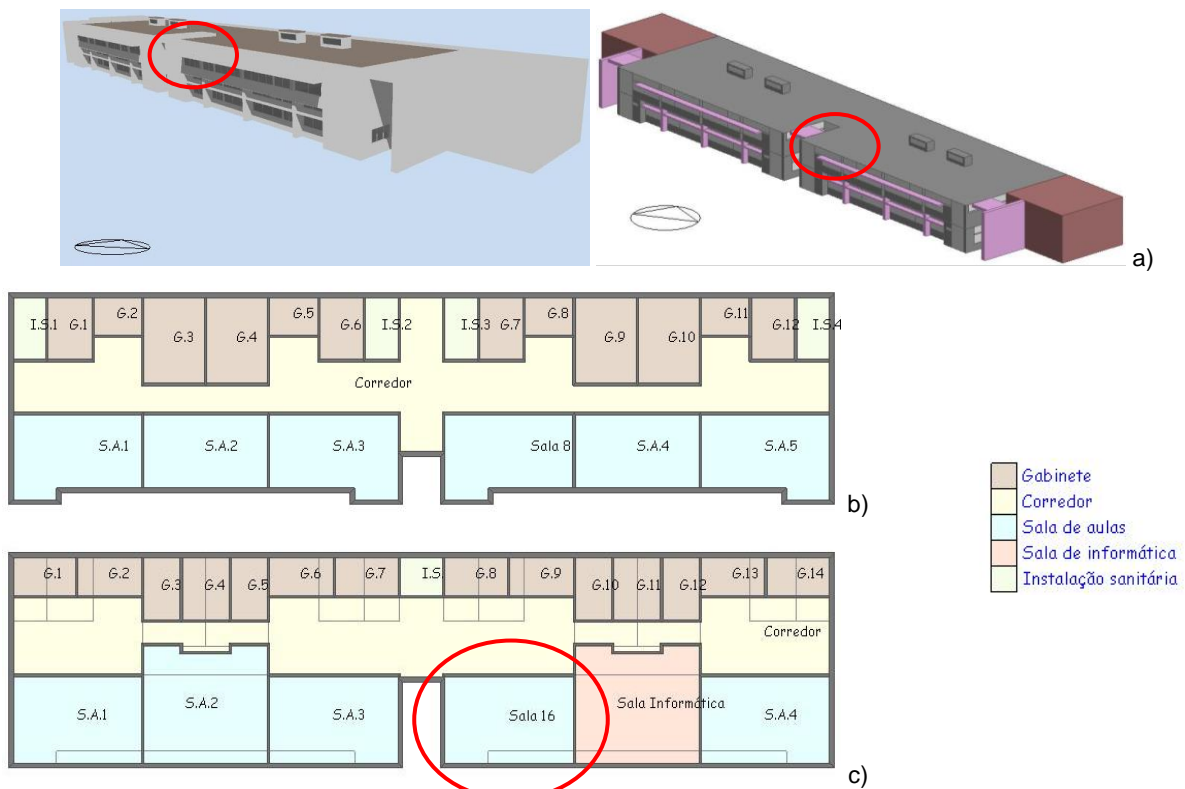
Modelo criado para o edifício pedagógico: a) vista exterior; b) planta do 1.º piso; c) planta do 2.º piso
